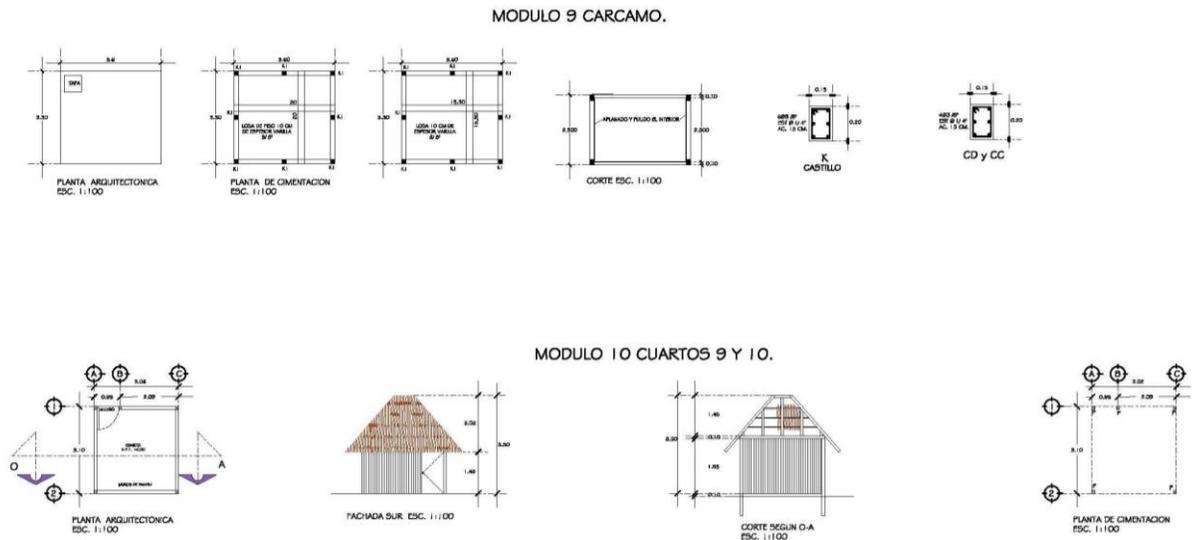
Plano arquitectónico del módulo 9 y 10.
